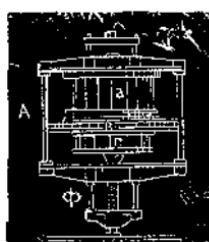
Пародѣйствующій коперь: А—станокъ; а—барабанъ для подъема бабы; в—шкивъ для привода отъ машины; с—барабанъ для подъема свай.
